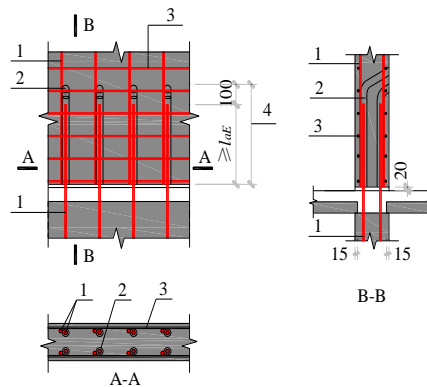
钢筋浆锚连接预制剪力墙构造
